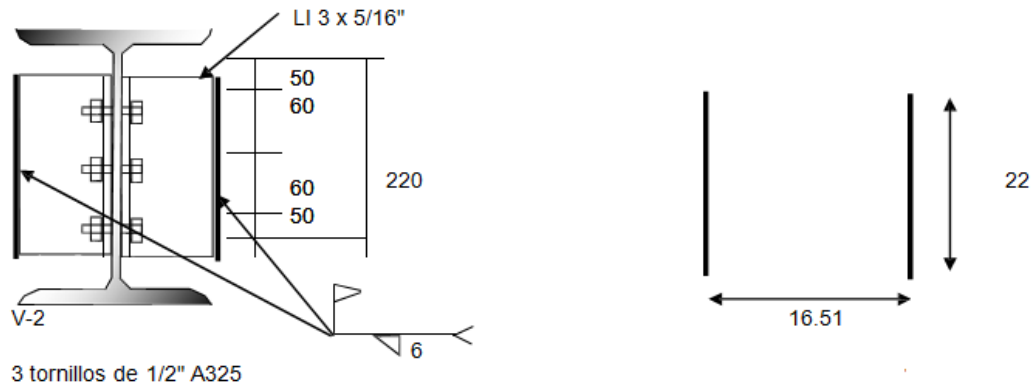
' Conexión 6, detalle y soldadura.
